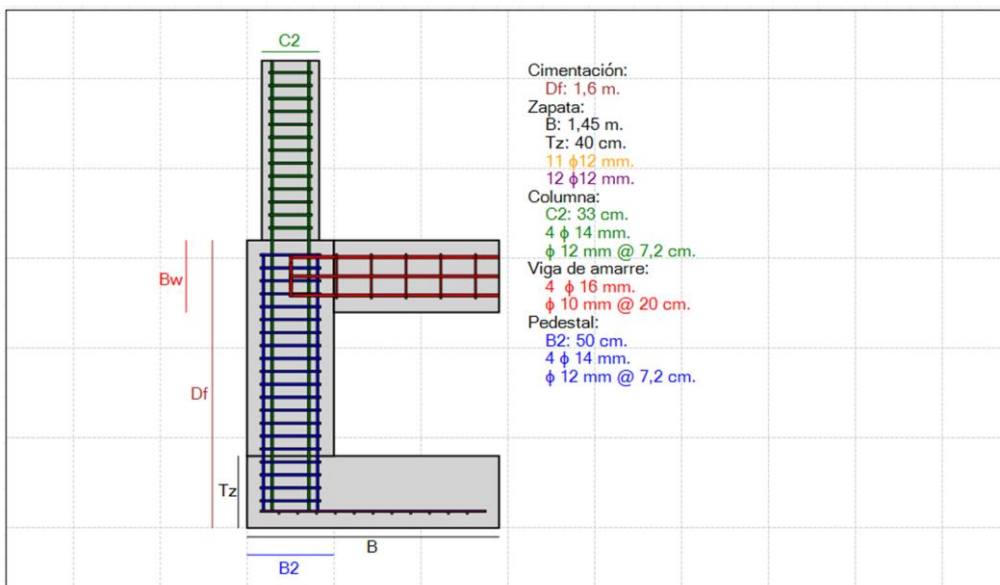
Nomenclatura de la cimentación en L, Caso 2.
